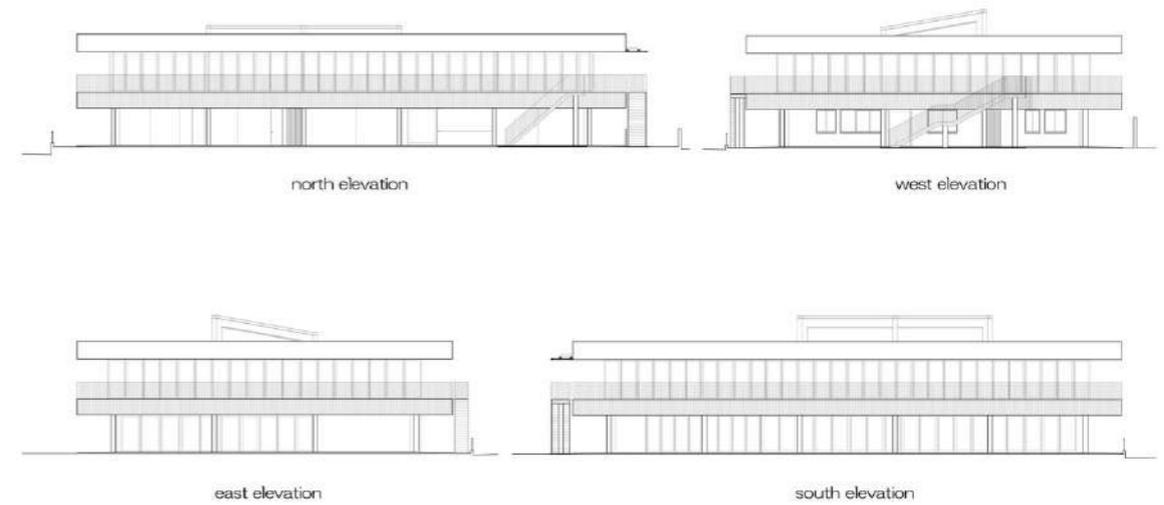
Alzados escuela. Fuente: <https://www.archdaily.com>
